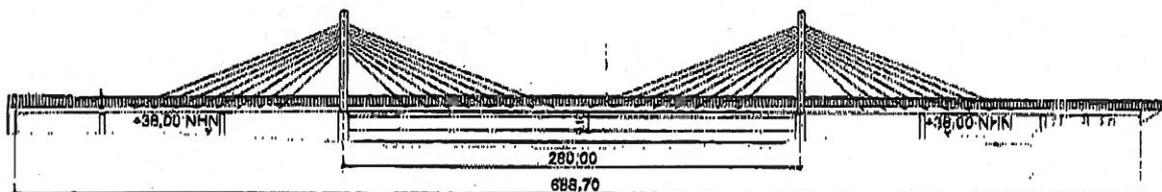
Bauwerksskizze der Rheinbrücke mit Hauptabmessungen
